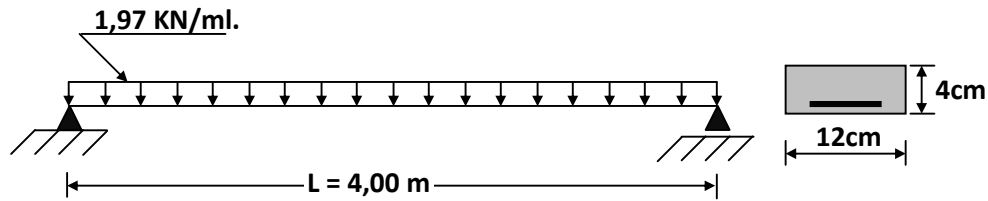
Schéma statique de la poutrelle avant le coulage
